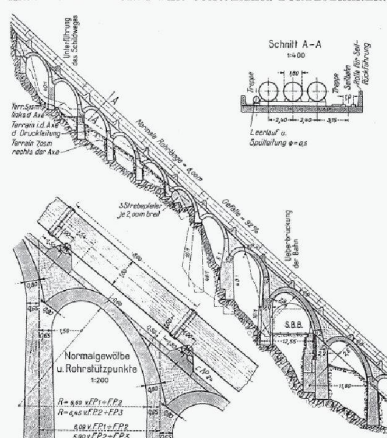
Unte: Bau der Druckleitung mit Kreuzung der Gotthardbahn. Länge- und Querschnitt 1:800, Detail (links unten) 1:200.
